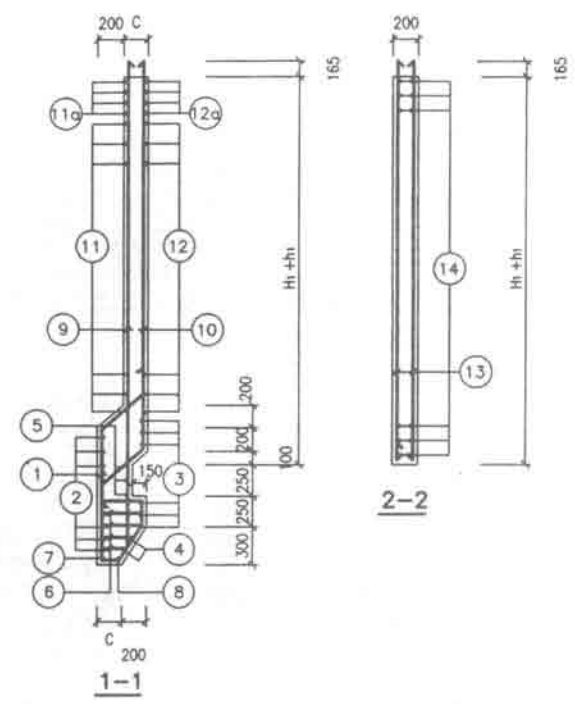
号、4号钢筋混凝土沉井化粪池 平、剖面图	图 集 号	91SB4-1
